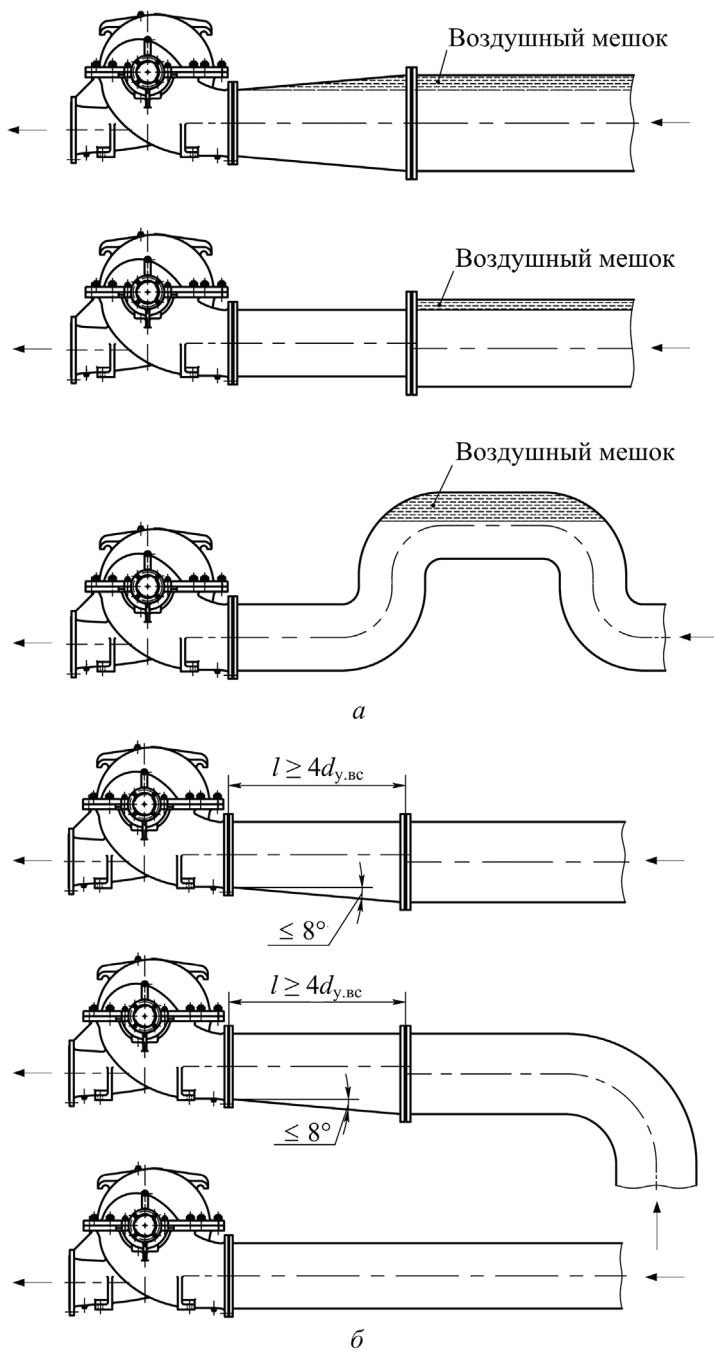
Примеры монтажа всасывающих трубопроводов насосов³²:
